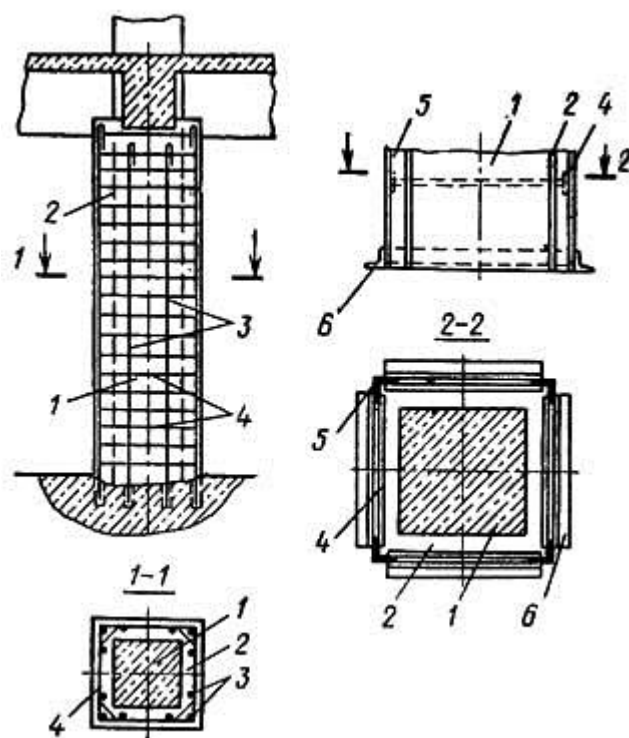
Усиление колонны железобетонной обоймой: 1 – усиливаемая колонна; 2 – обойма; 3 – продольная арматура обоймы; 4 – поперечная арматура обоймы; 5 – жесткая продольная обойма; 6 – опорные уголки
